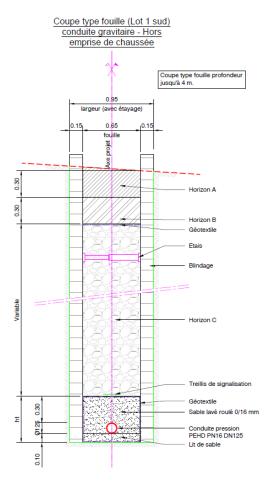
Coupes-type conduite pression hors emprise de chaussée
